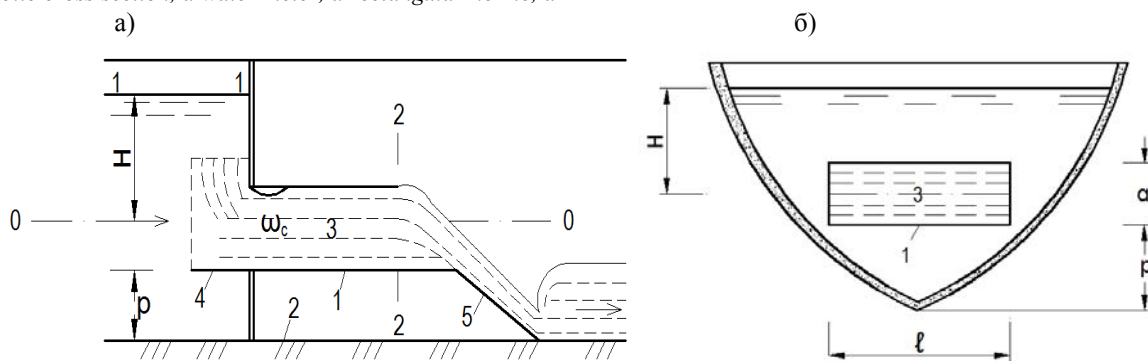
Схема «Прямоугольного насадка» на лотковом канале с параболическим сечением. а – продольный разрез; б – поперечное сечение водотока (вид с верхнего бьефа).
